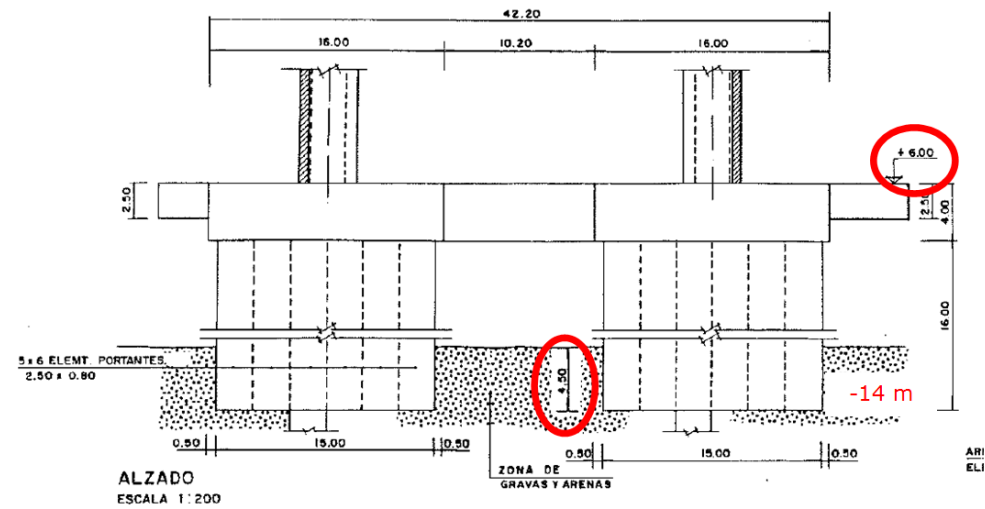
Alzado de la cimentación del pilono P-14. (copiada del Proyecto Modificado n° 1)
